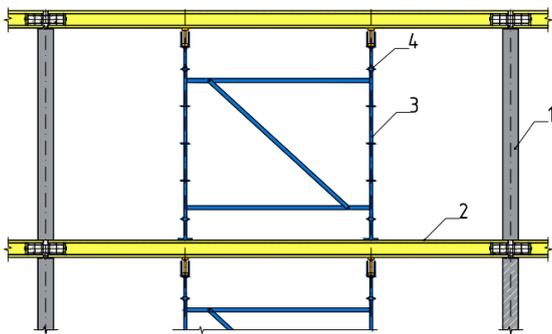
Схема монтажа, выверки и временного закрепления многупустотных плит перекрытия на пространственных стальных рамах с домкратами до их замоноличивания с сохранением обратного выгиба
